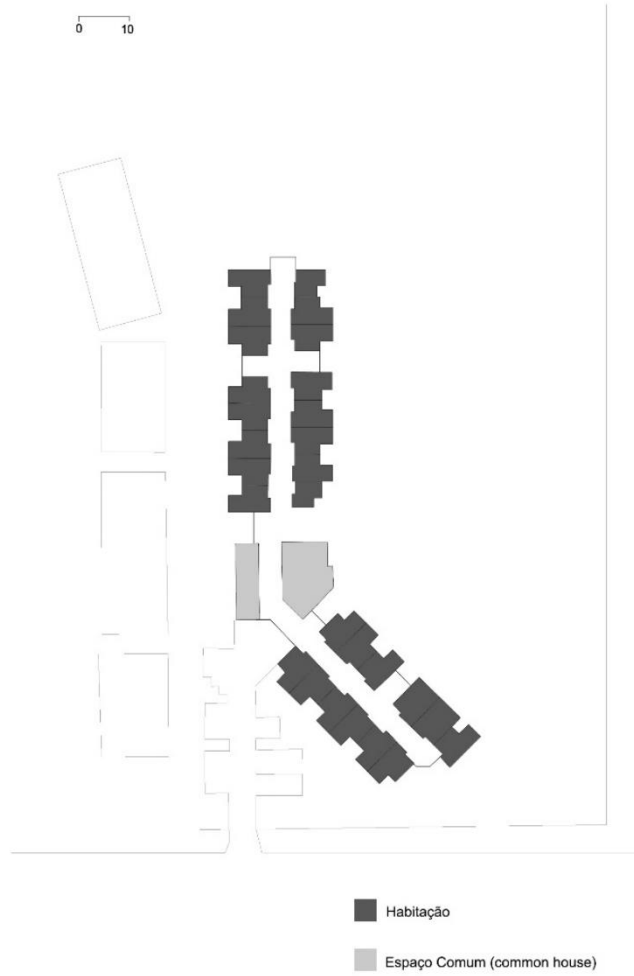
Planta de implantação de WindSong, escala 1.1000 . Editado pela autora
